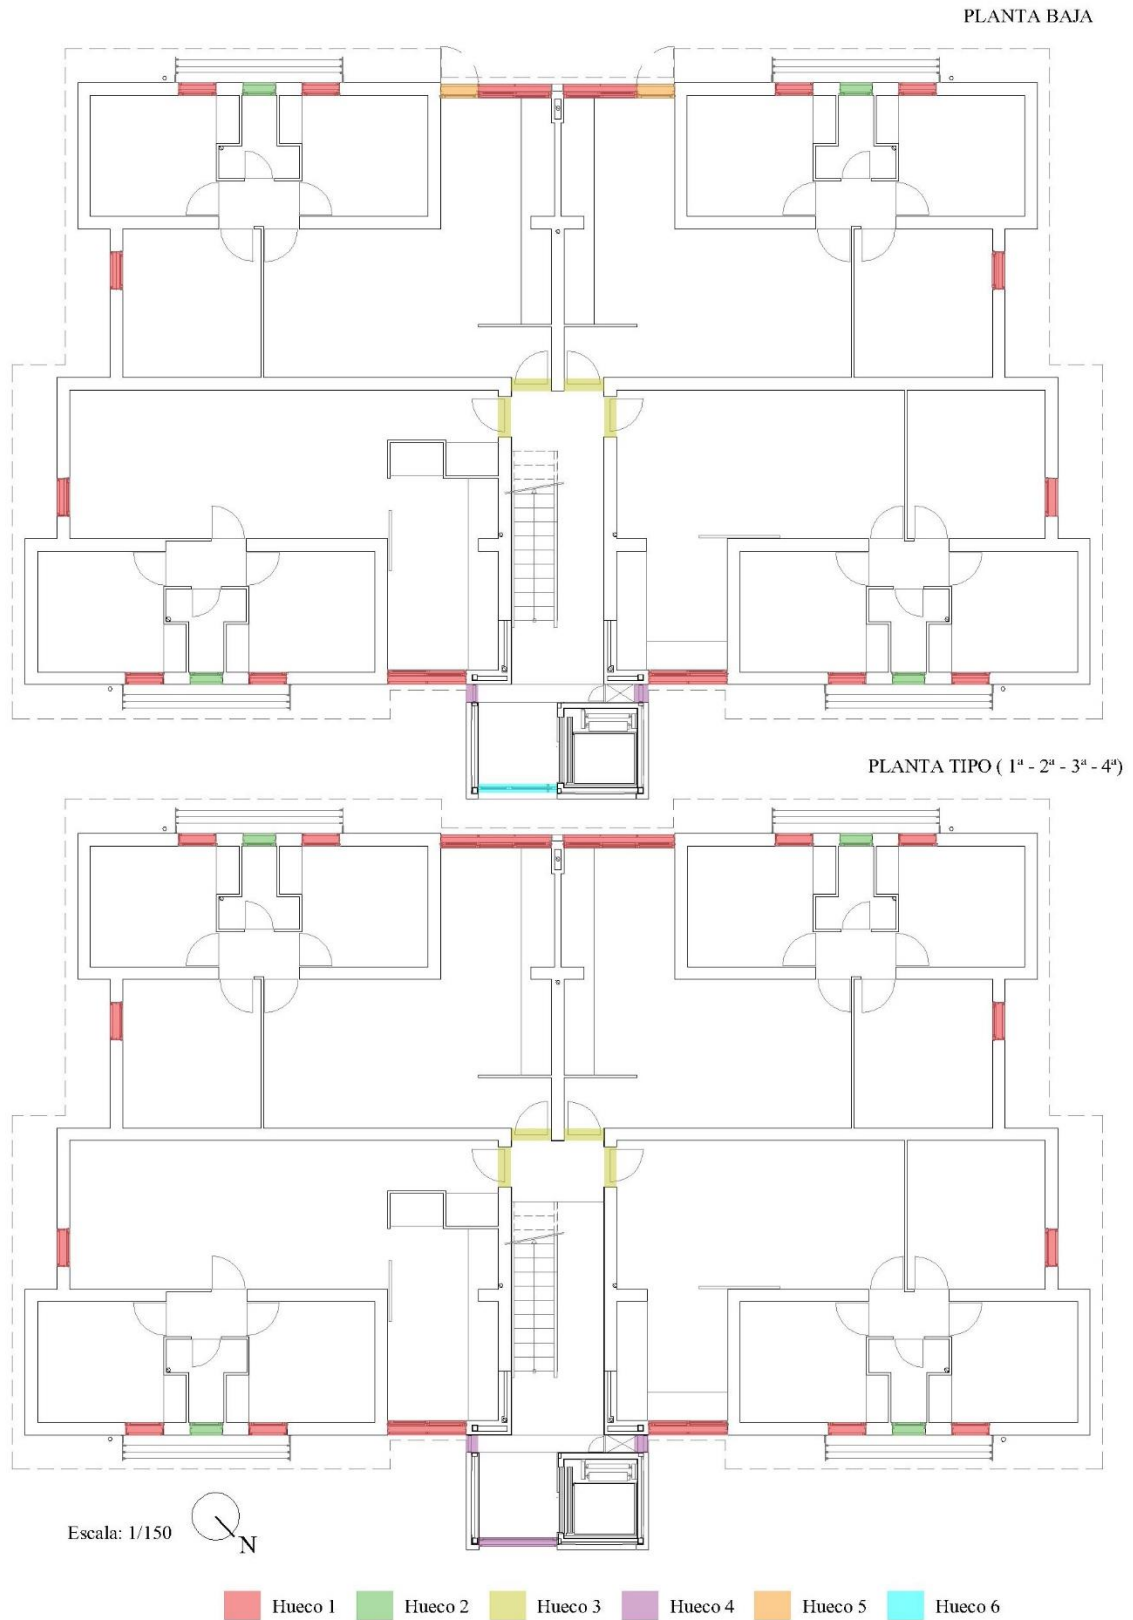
Planimetría EA de tipología de huecos. Fuente: Elaboración propia.
